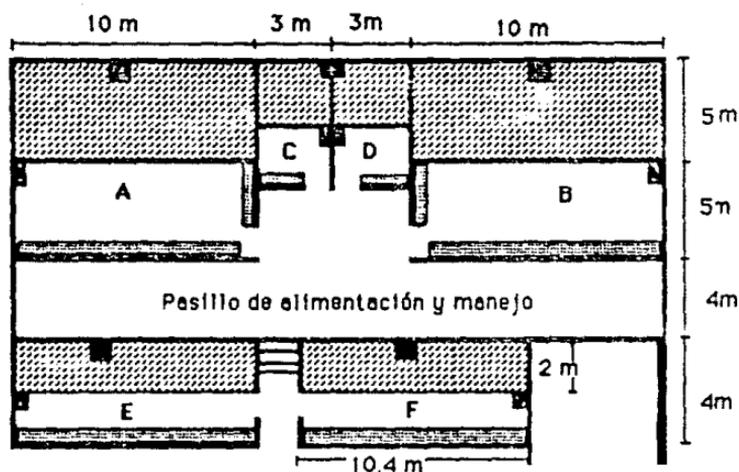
Vista de la planta del rancho "El Savinoco"
